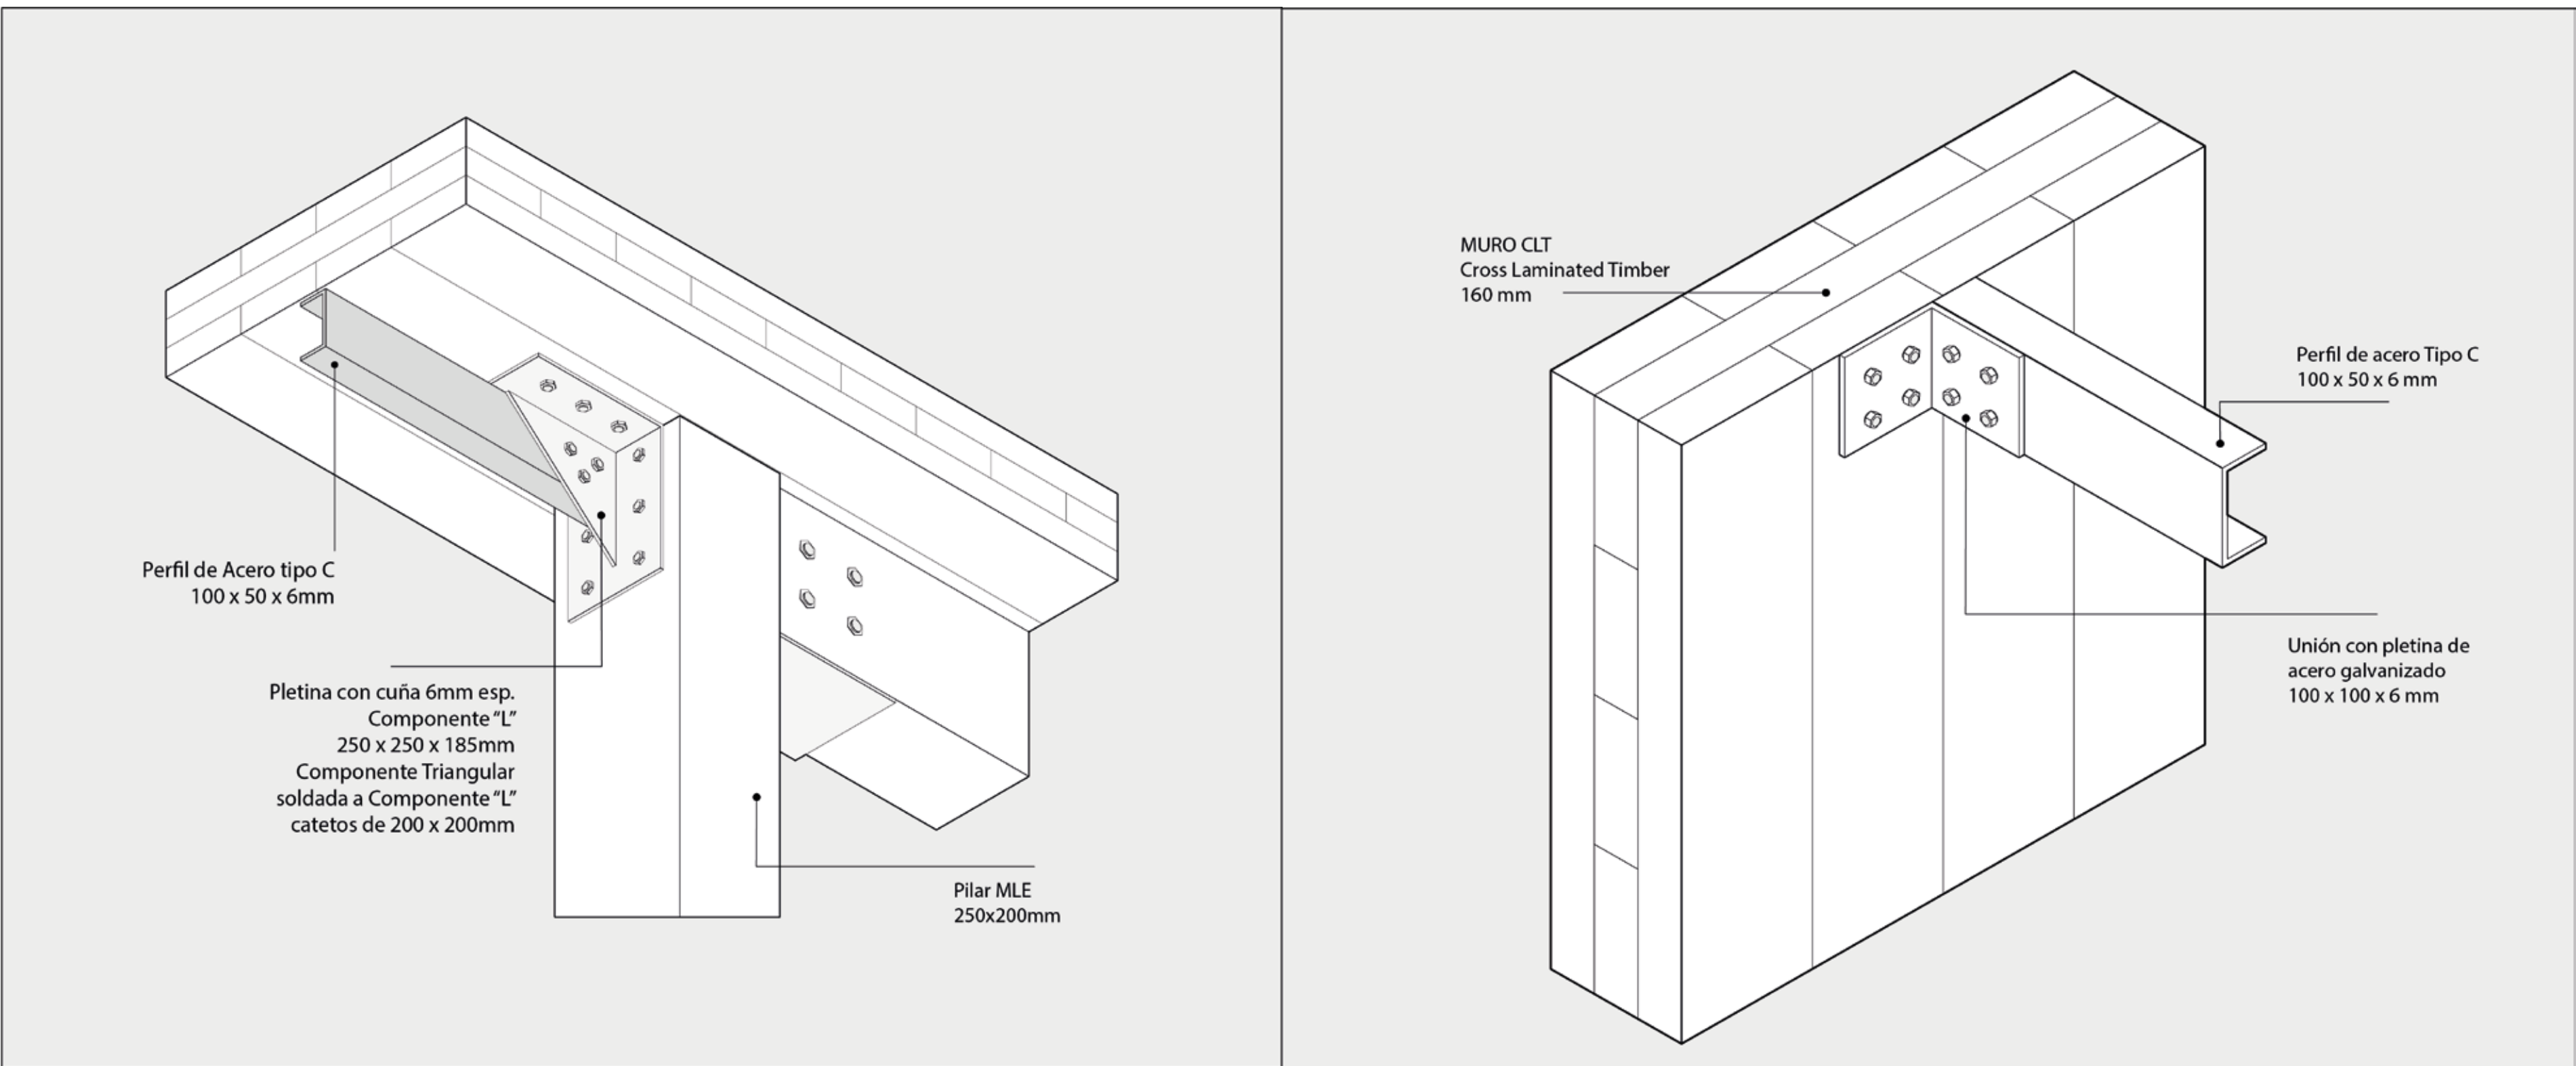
y 13: Detalles constructivos pieza de unión en acero
